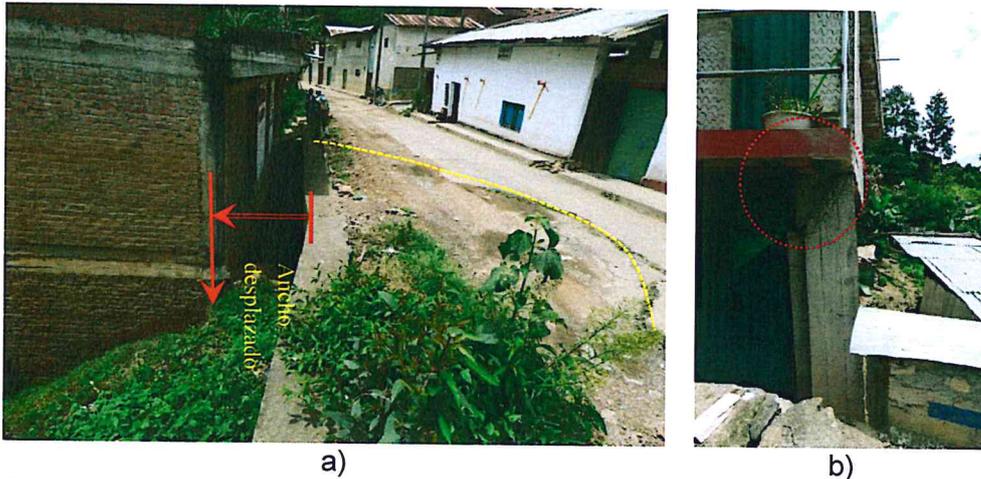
a) Edificación con desplazamiento horizontal y vertical con respecto al muro de contención del pavimento. En líneas discontinuas amarillas se muestra la subsidencia del pavimento. b) Columna de edificación fracturada con desplazamiento aproximadamente 5 cm.
